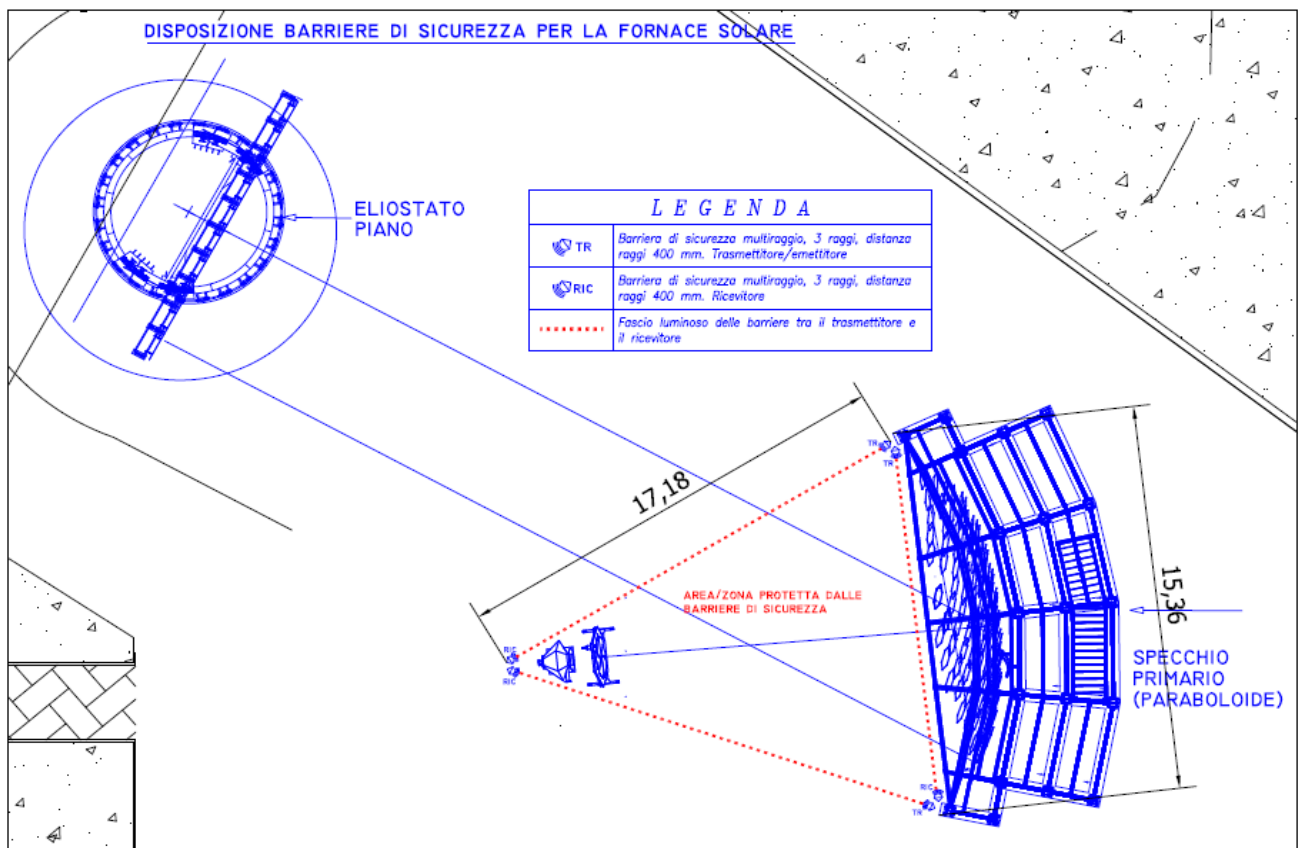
Layout di montaggio delle barriere ad infrarossi a protezione dell'area interdotta tra il paraboloide ed il ricevitore della fornace solare
